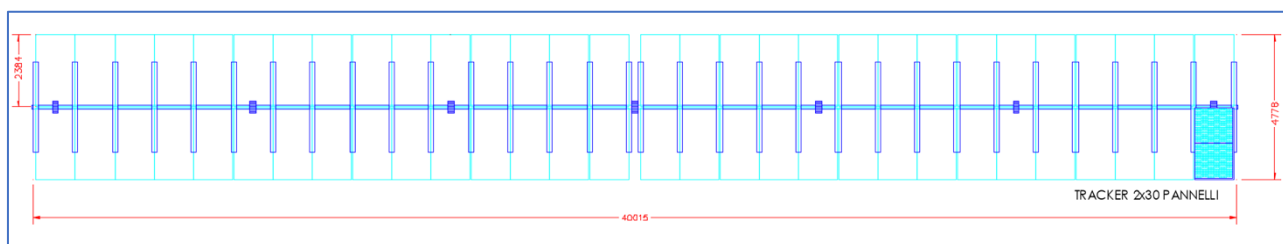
Vista in pianta struttura di sostegno moduli fotovoltaici
